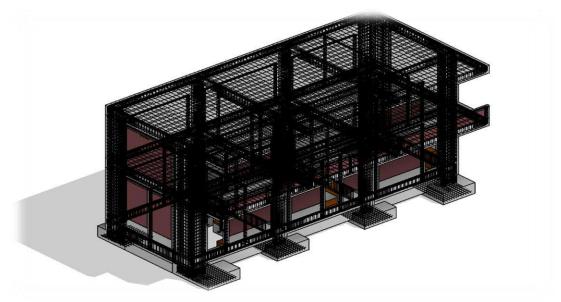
Modelo BIM, Acero Corrugado en Modulo B.
